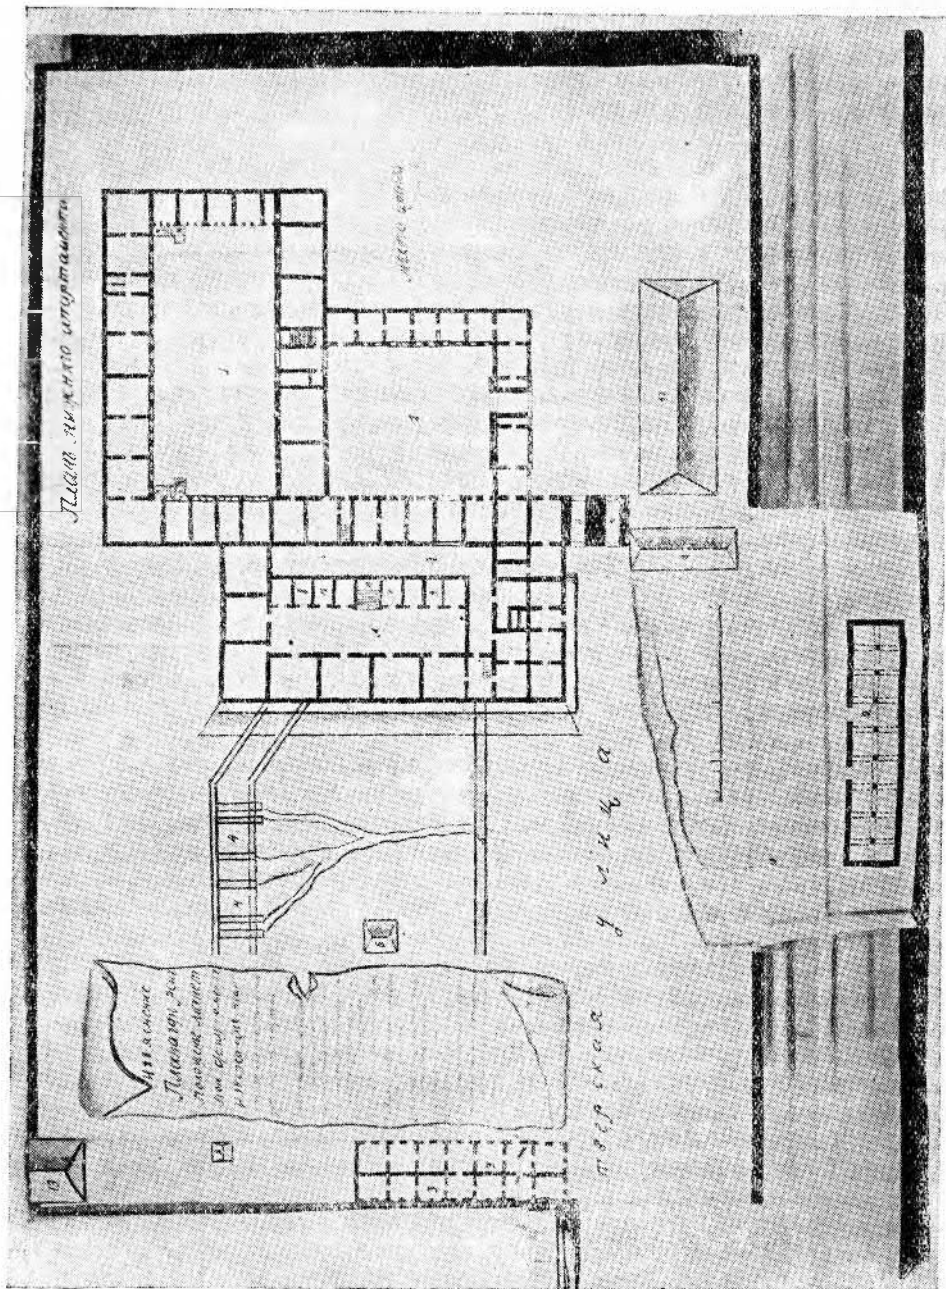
План Монетной экспедиции. Нижний этаж (ЦГАДА).
